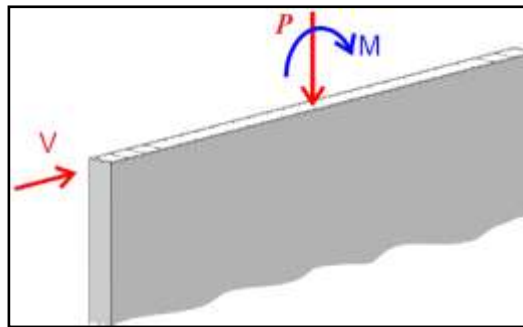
45.- Fuerzas actuantes en muros de corte
